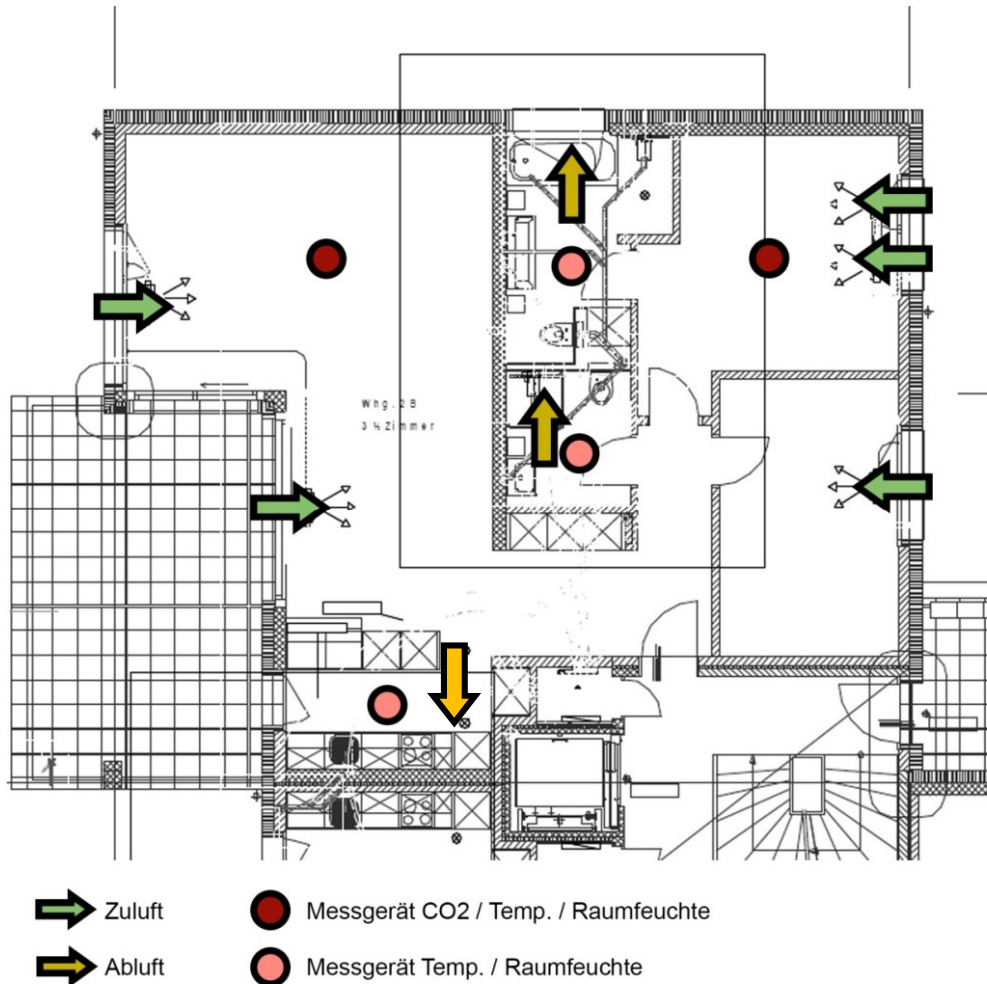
MFH Malters: Grundriss Wohnung C
